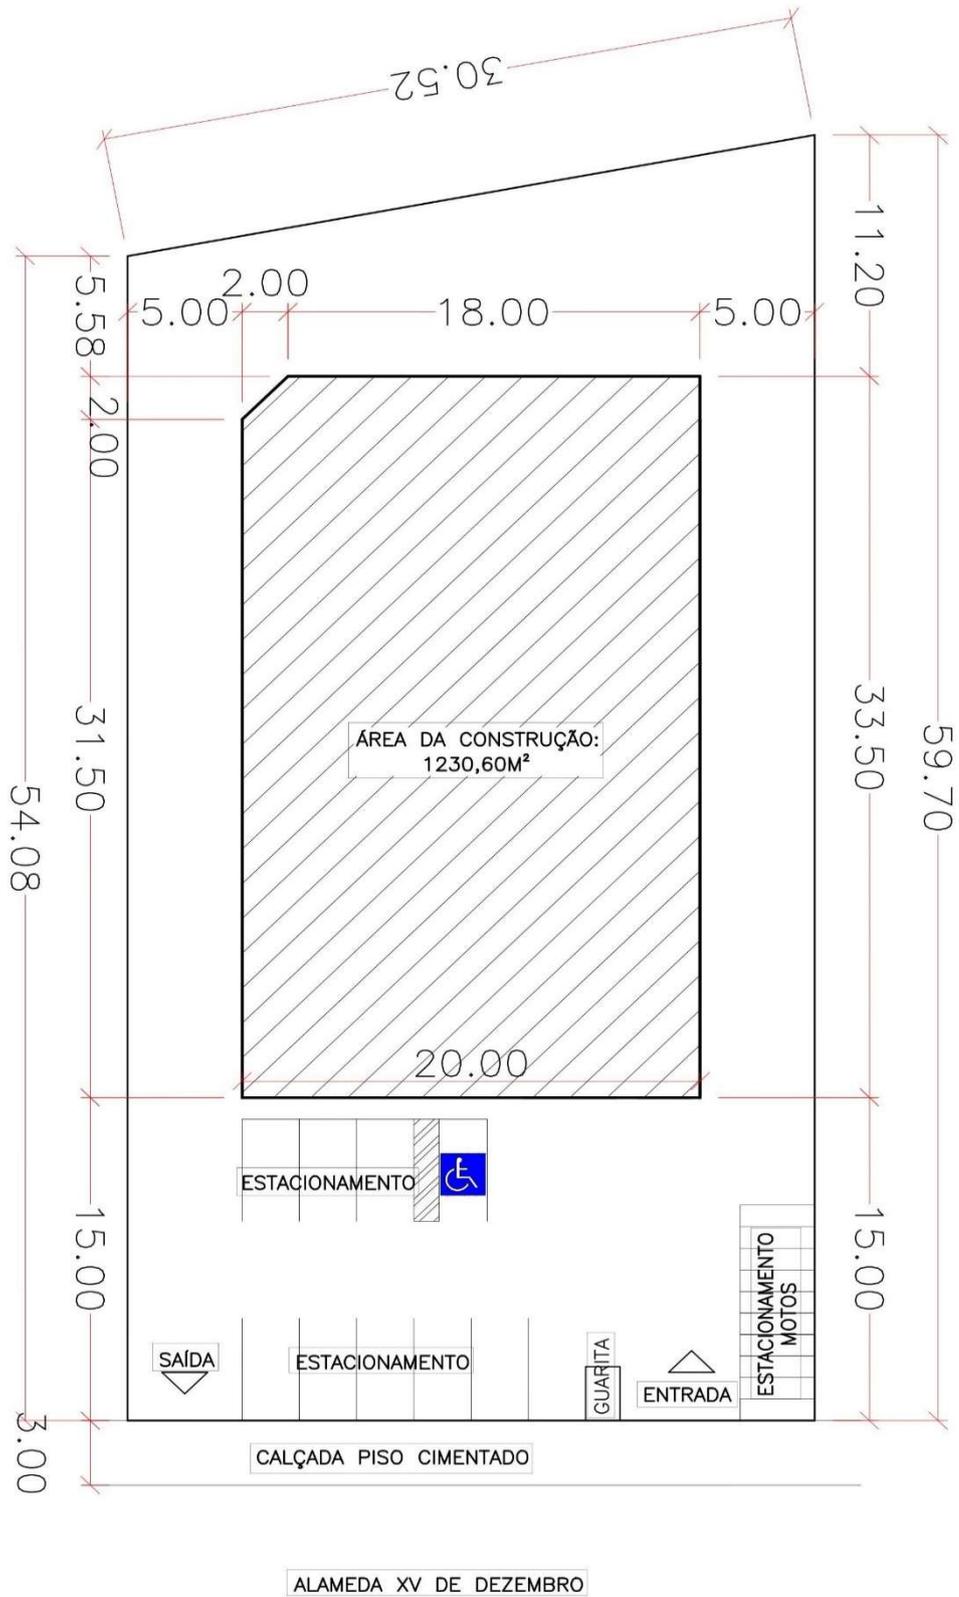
CROQUI DE IMPLANTAÇÃO , ESCALA: 1:200.
